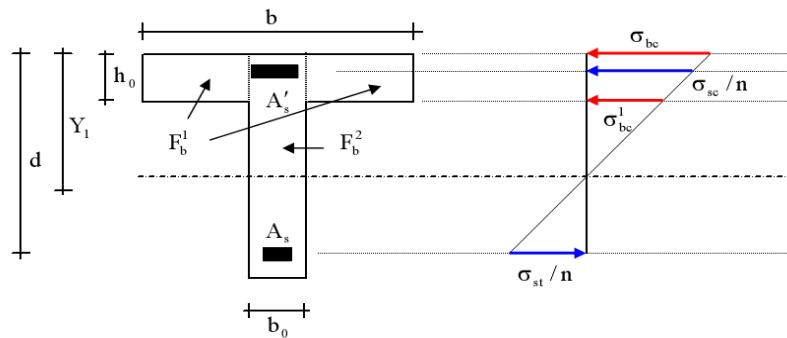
Notations utilisées pour le calcul de section d’acier pour une poutre en T
